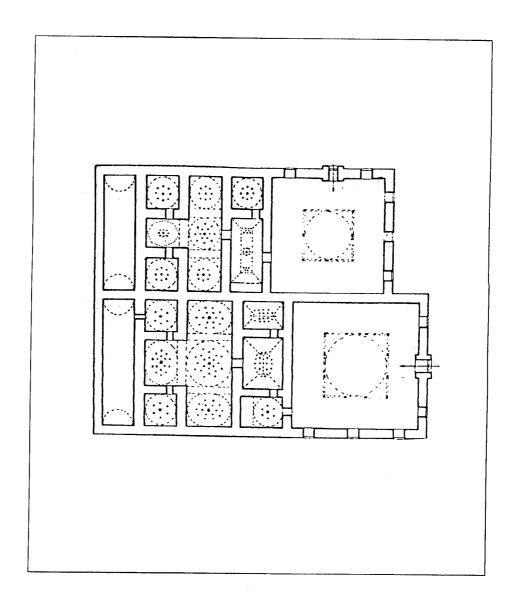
مكرر) مسقط أفقي لحمام خاصكي حرم بإستانبول (عن : جودوين)
